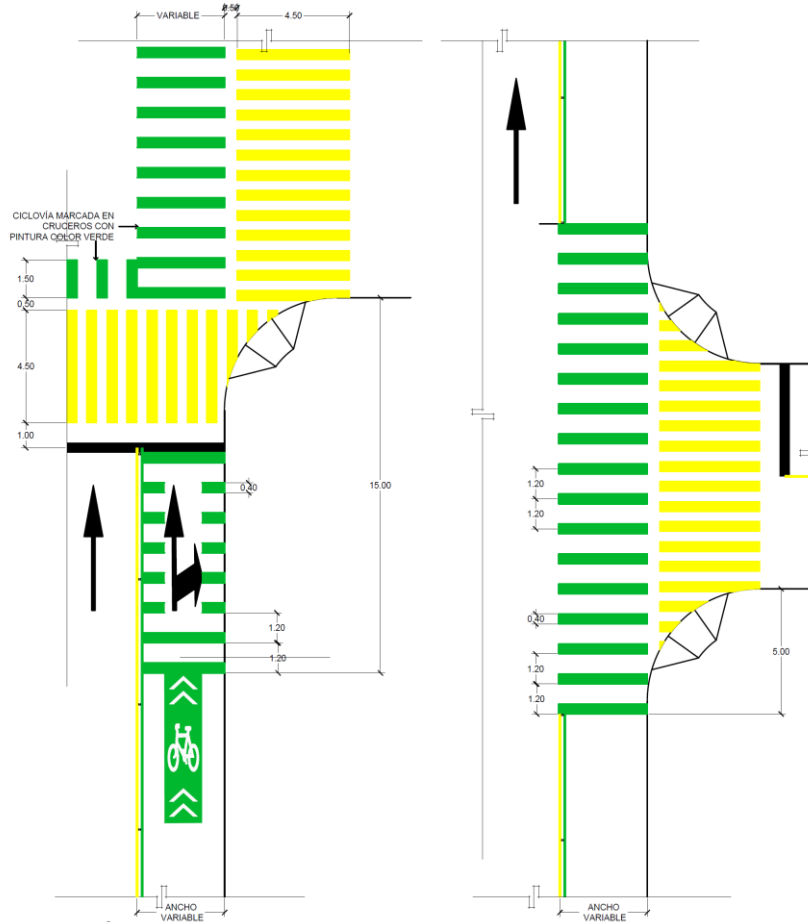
Detalle de señalamiento horizontal Tipo 2.
